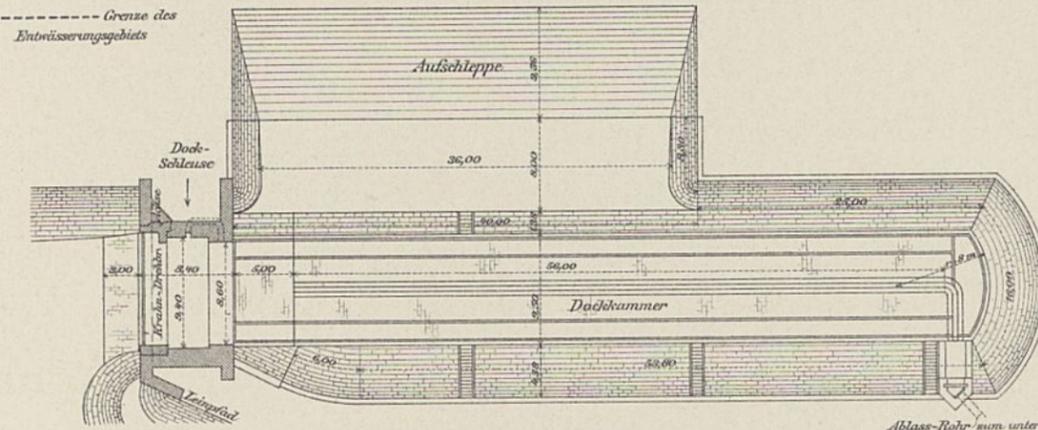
Grundriss des Docks. 1: 600.
